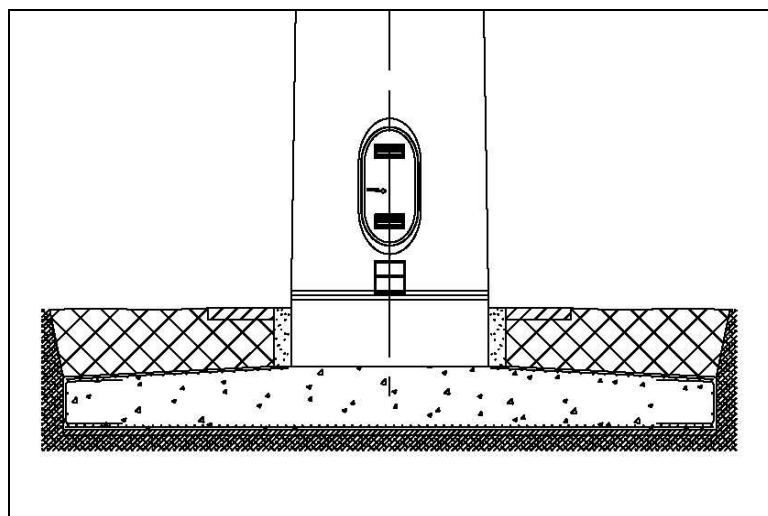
Schéma-type d'une fondation (source : GAMESA, 2014)
